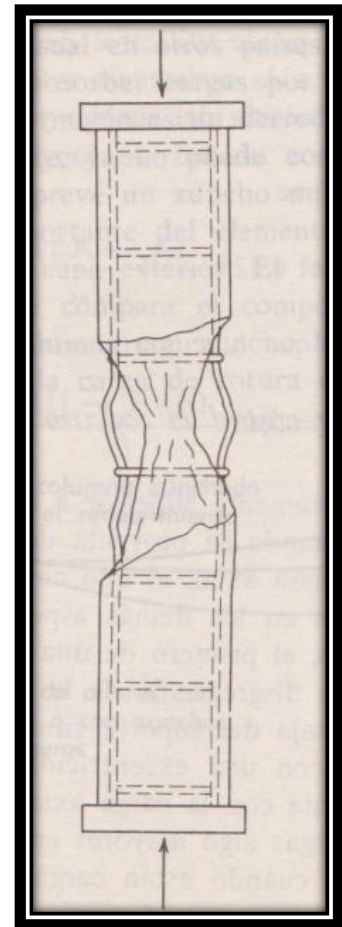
12. Falla por aplastamiento del Hormigón de una columna. Referencia 14.
